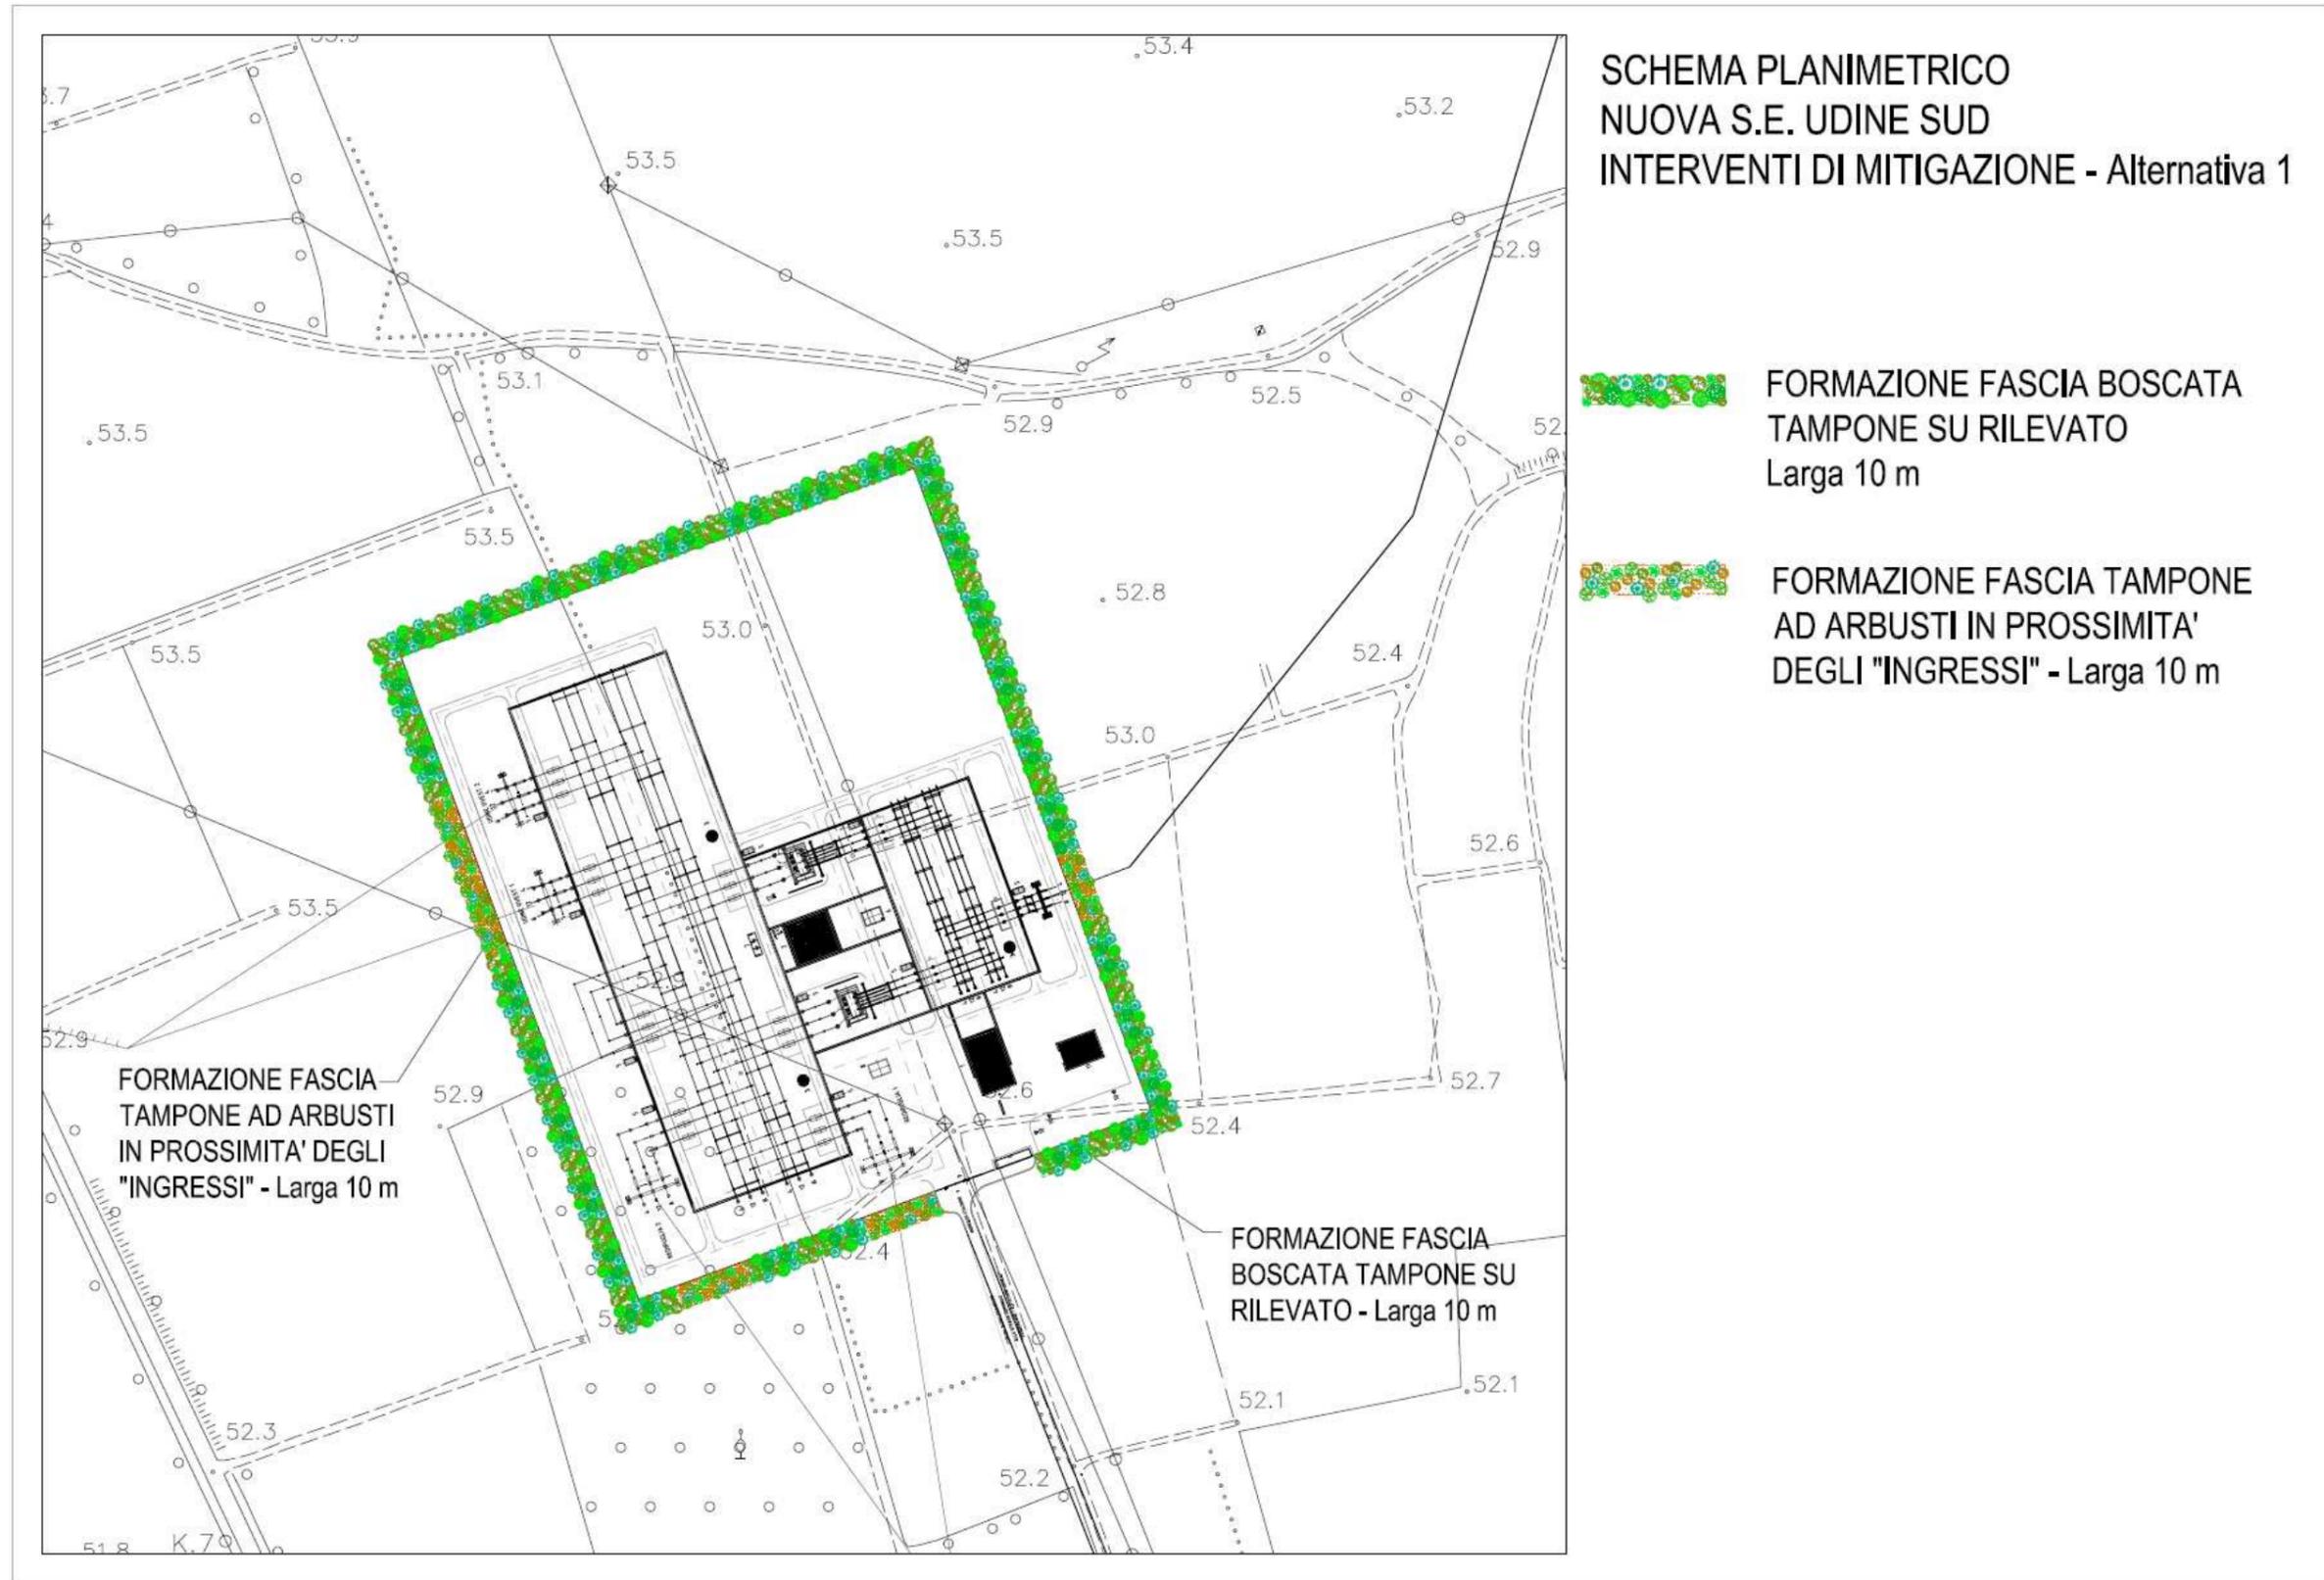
A- Planimetria Nuova stazione Udine Sud alternativa con Formazione Fascia boscata su rilevato
